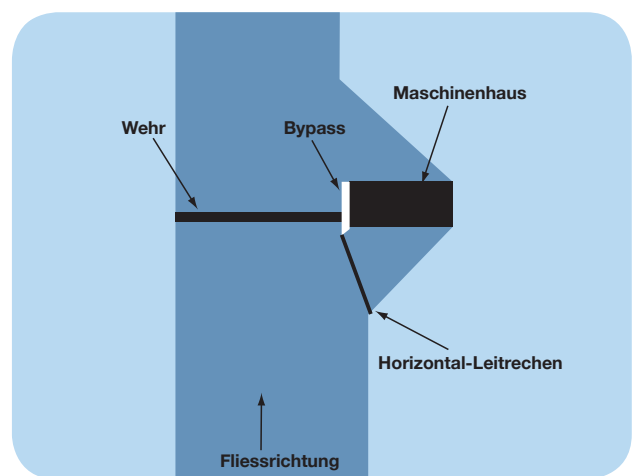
Prinzip der vorgestellten Anlagen im Grundriss.
